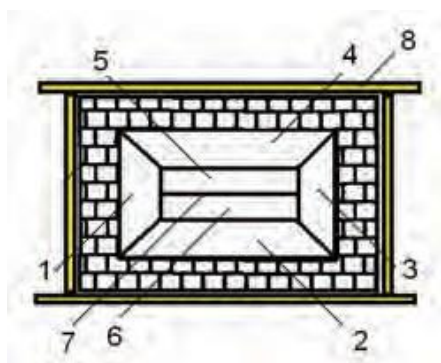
Схема предохранительной разрушающейся конструкции ограждения зданий
